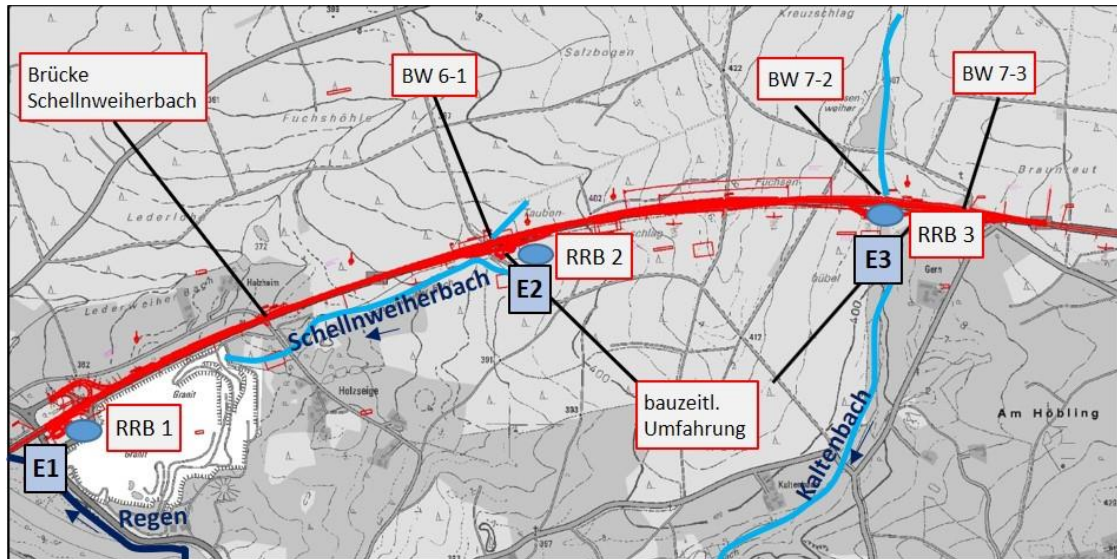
Ausbauabschnitt A B 16 "Regensburg – B 85 (Roding), dreistreifiger Ausbau bei Nittenau mit Bauwerken und schematischer Darstellung Planung der Straßenentwässerung (E = Einleitungsstelle Straßenwasser)
